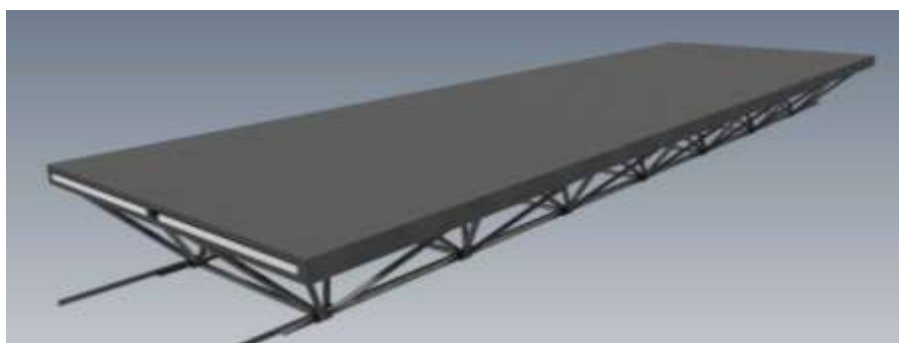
Загальні вид просторової ферм з залізобетонною плитою
